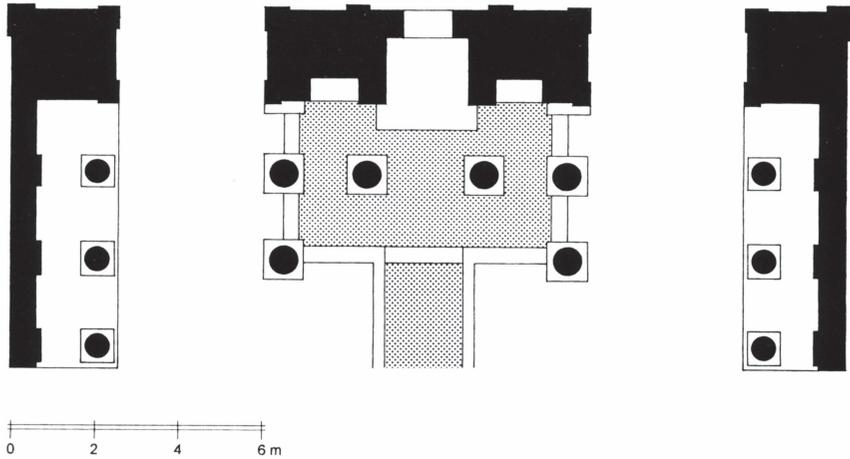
Grundrissrekonstruktion des Nymphäums F3 in Perge, Planzeichnung: I. Ponfick, nach DORL-KLINGENSCHMID 2001, 228 Abb. 158
